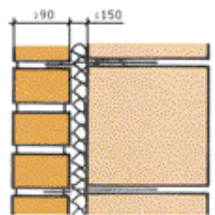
Двухслойная облицовочная кладка с промежуточным слоем теплоизоляции
